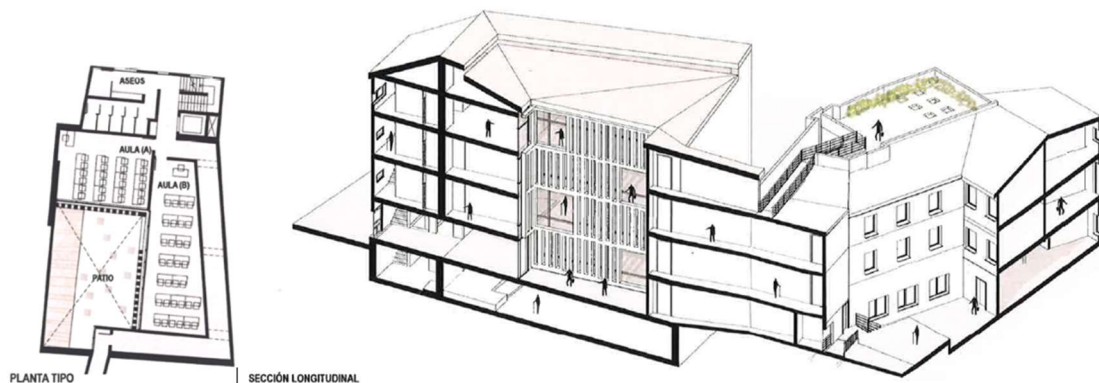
Detalle de la planta piso tipo y la sección longitudinal (escala 1:100) en la lámina 2/2 de la documentación presentada por el licitador
